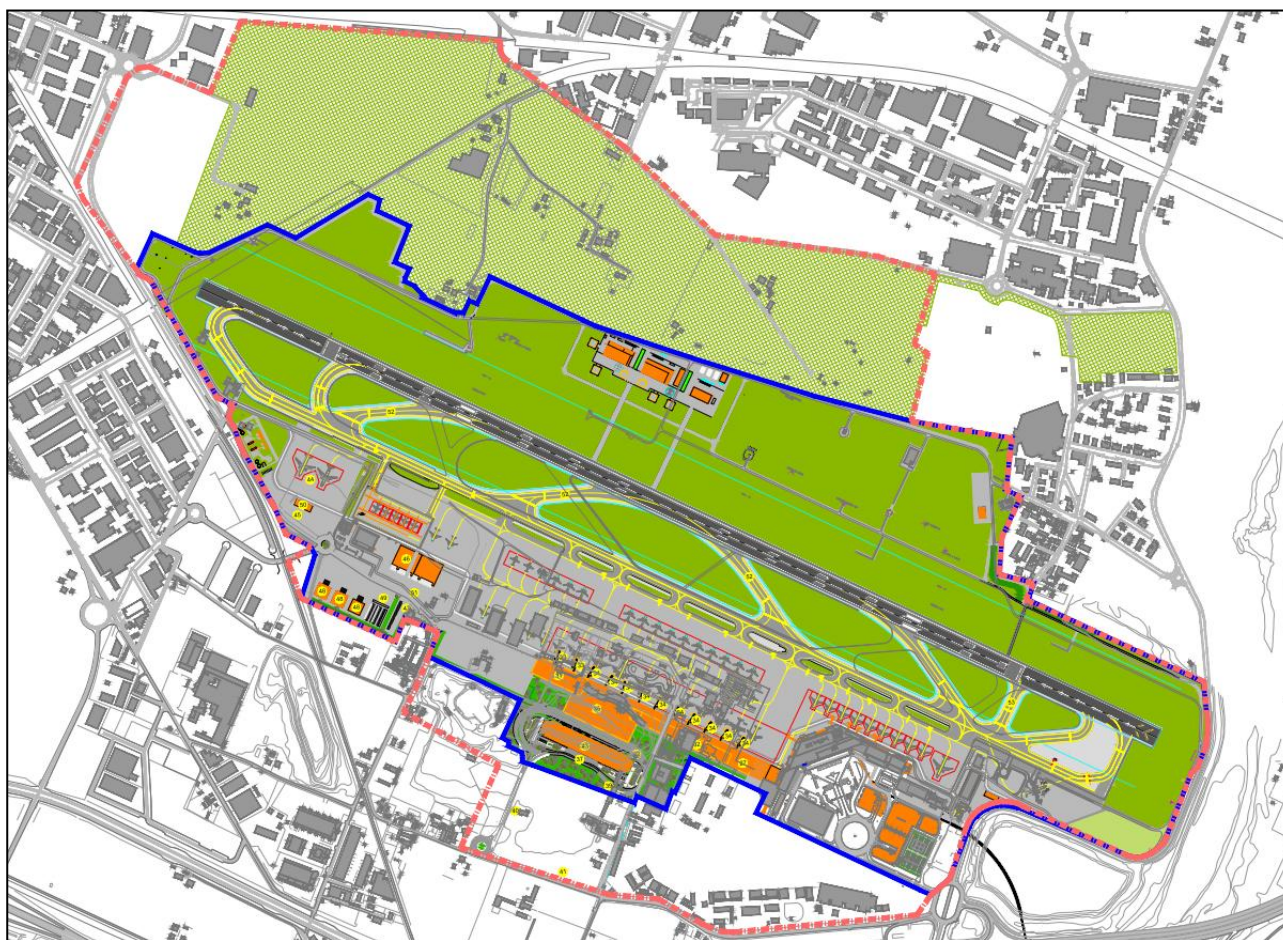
Rappresentazione dell'assetto finale a seguito del progetto di espansione previsto nel Master Plan.
